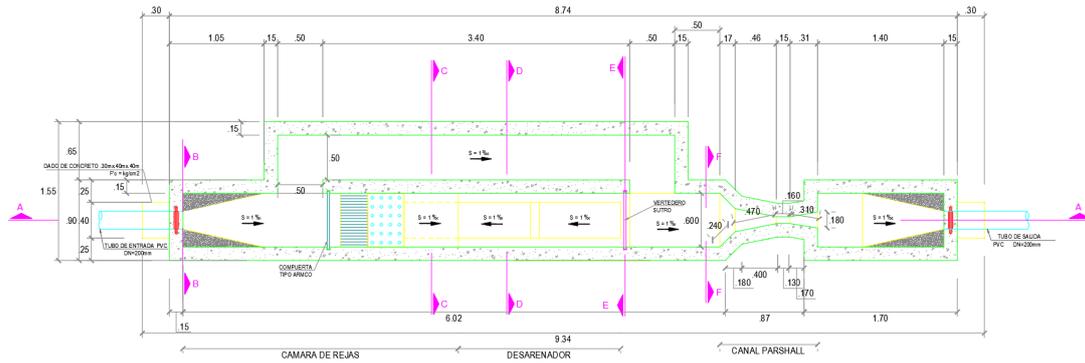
Planta de Cámara de Rejas, Desarenador y Canal PARSHALL
